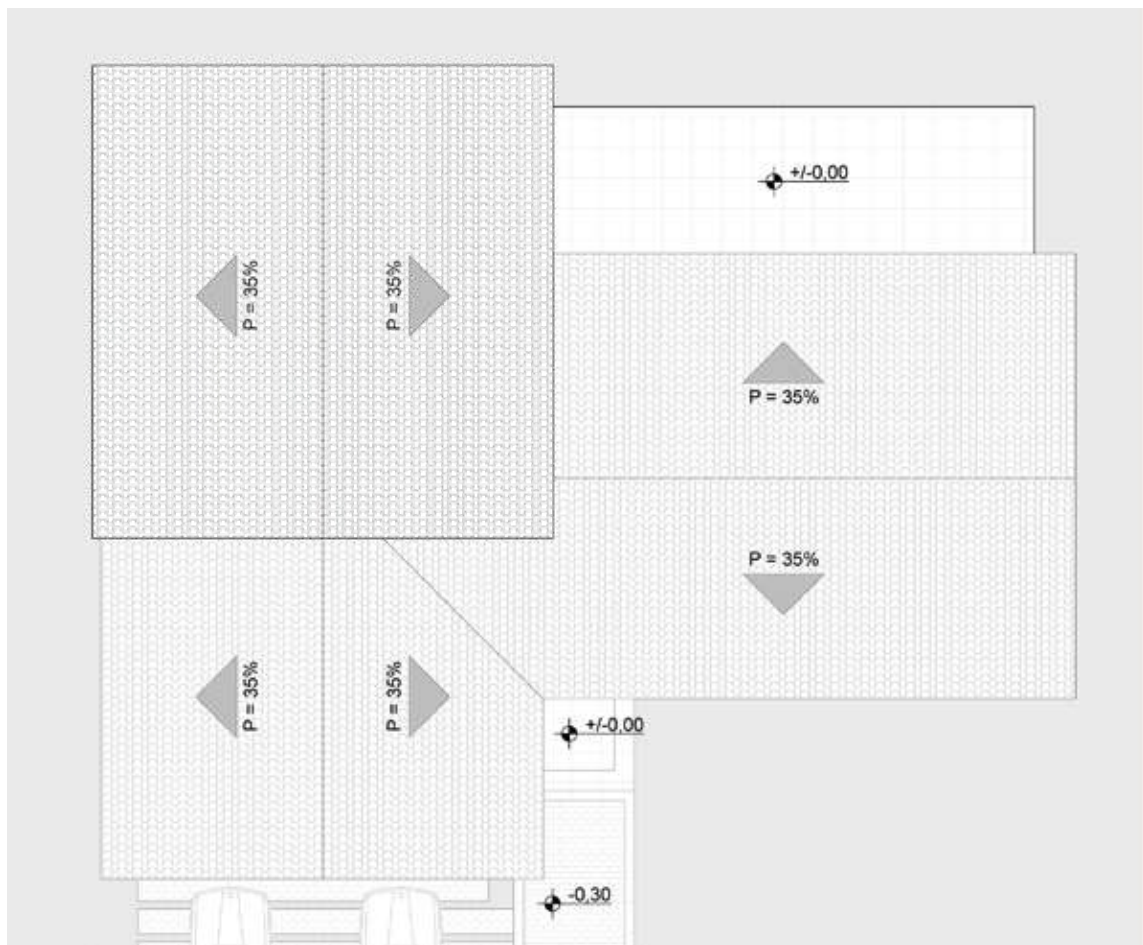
Planta de cubiertas - vivienda unifamiliar
